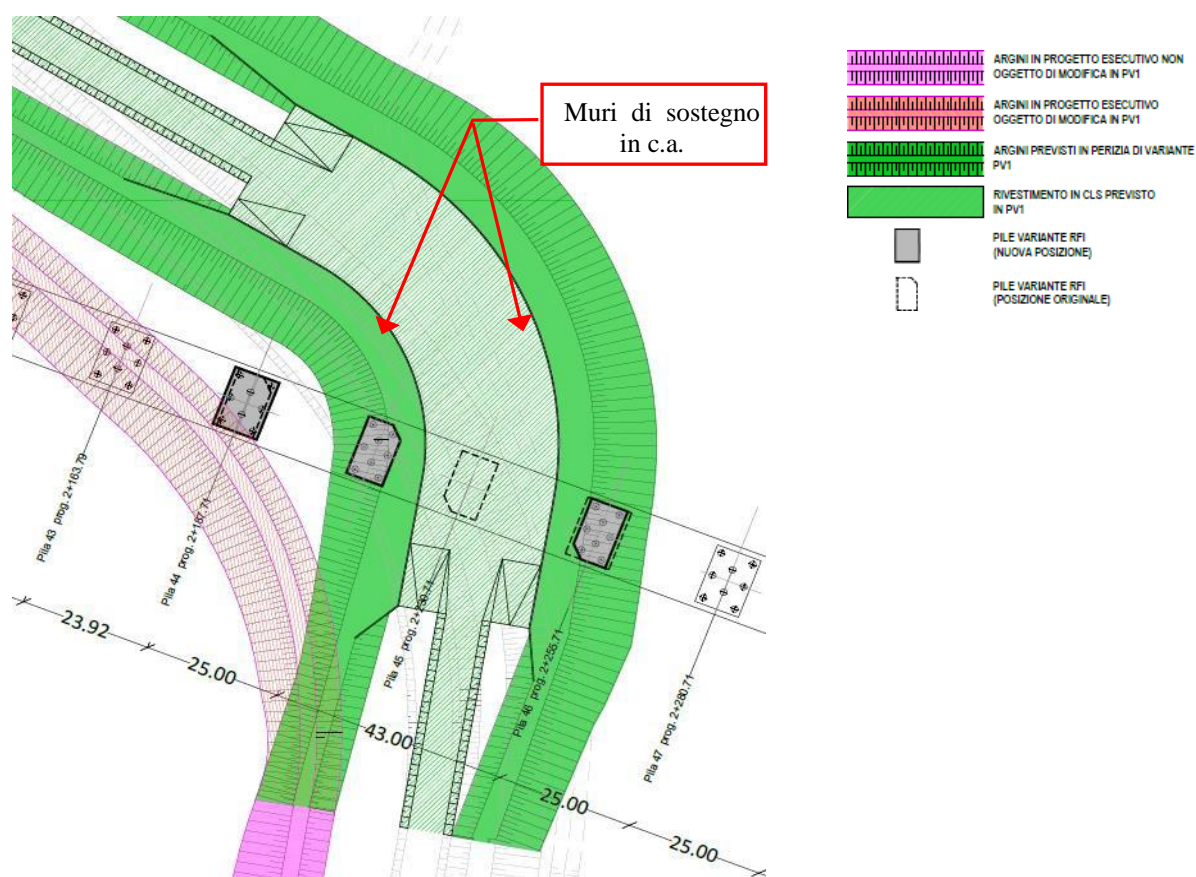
Stralcio planimetrico del tratto in variante del Canale della Liscia interferente con il Viadotto Esino
